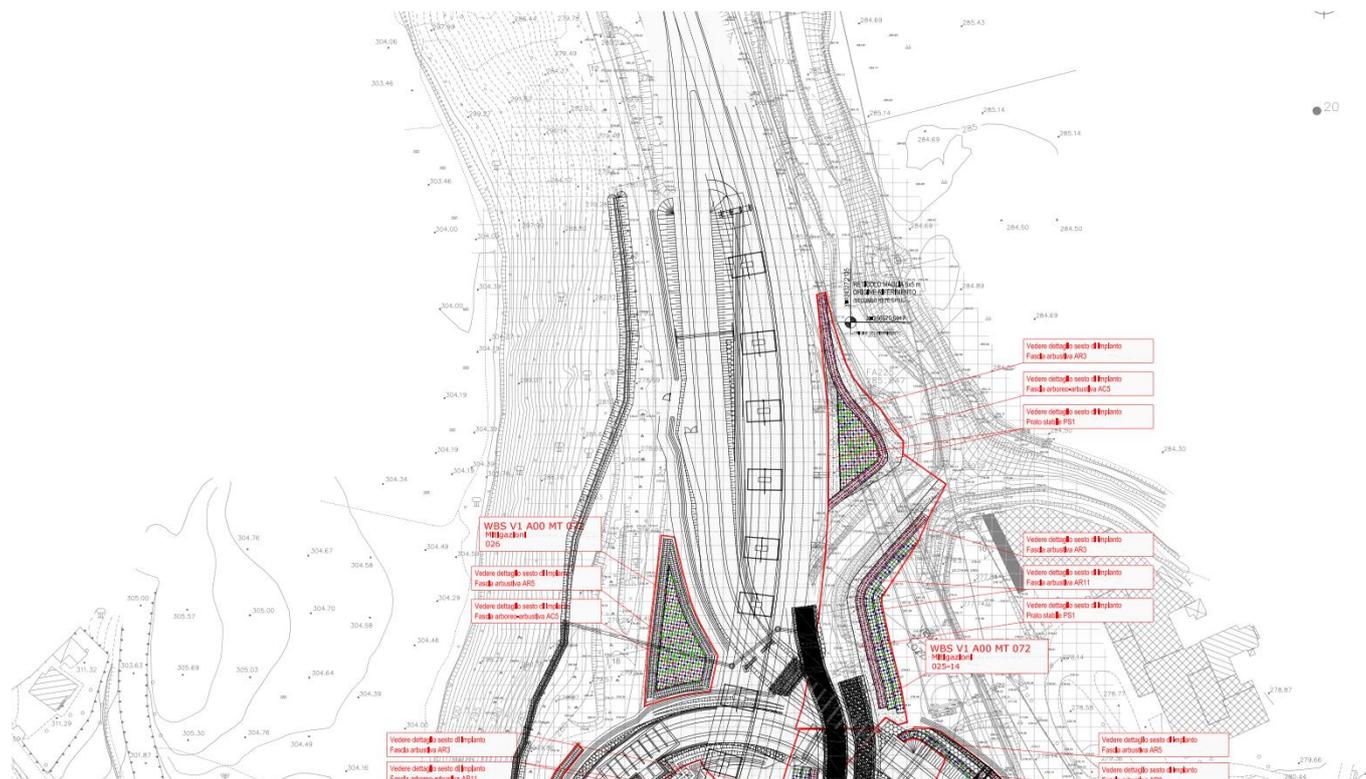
planimetria as built delle mitigazioni a verde nell'area del fiume Olona (A60)
